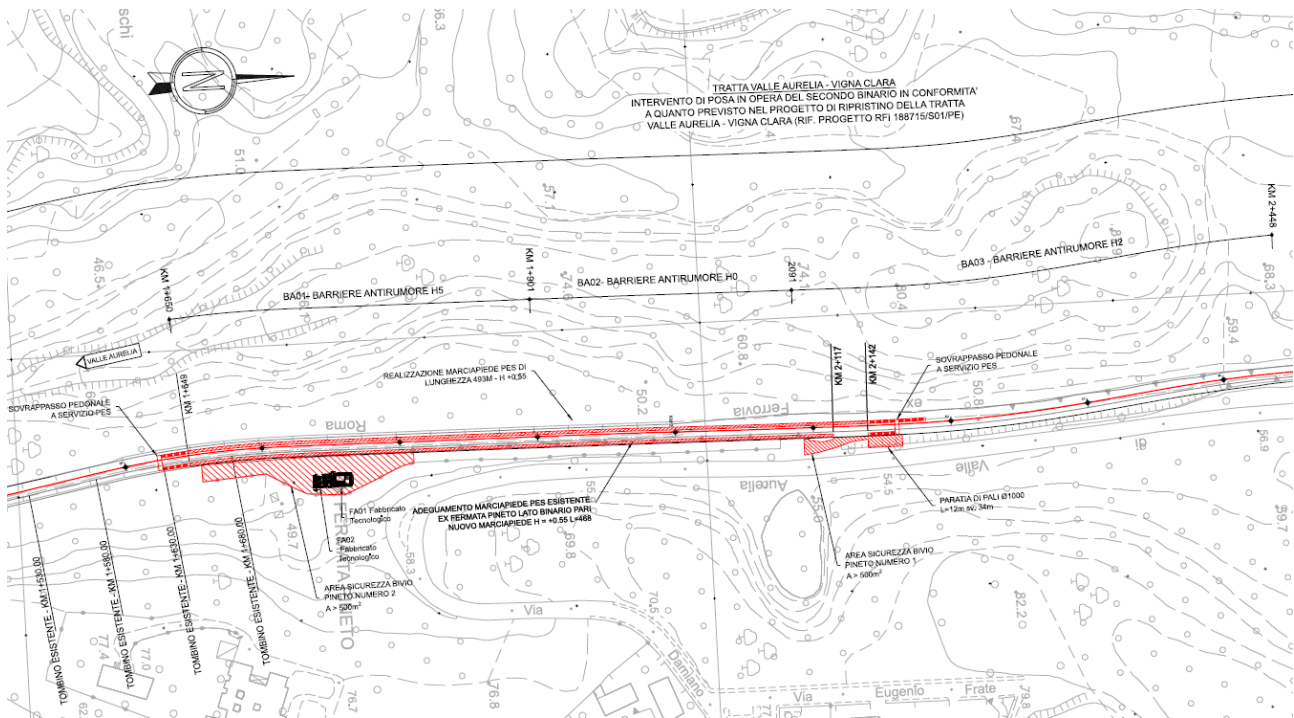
Stralcio planimetrico zona PES bivio Pineto
